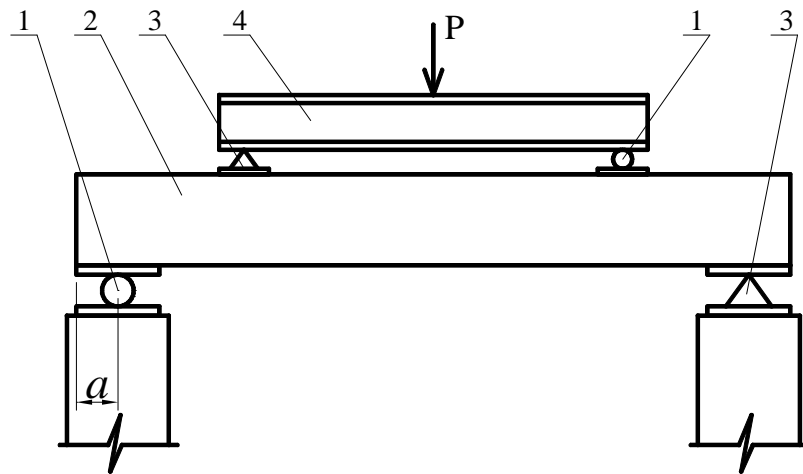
Схема испытания балочной конструкции: 1 – подвижная опора; 2 – испытываемая конструкция; 3 – неподвижная опора; 4 – распределительная балка
